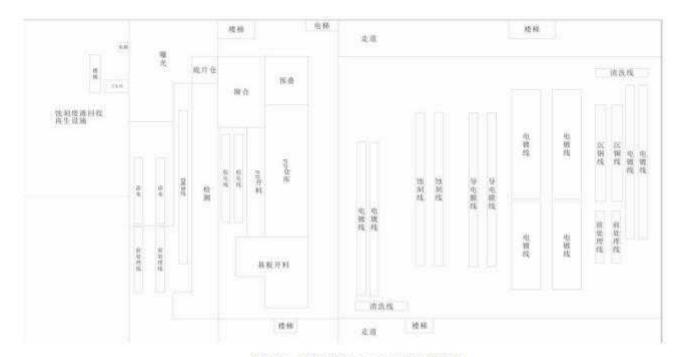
项目厂房 2.3.4 二层平面布置图
